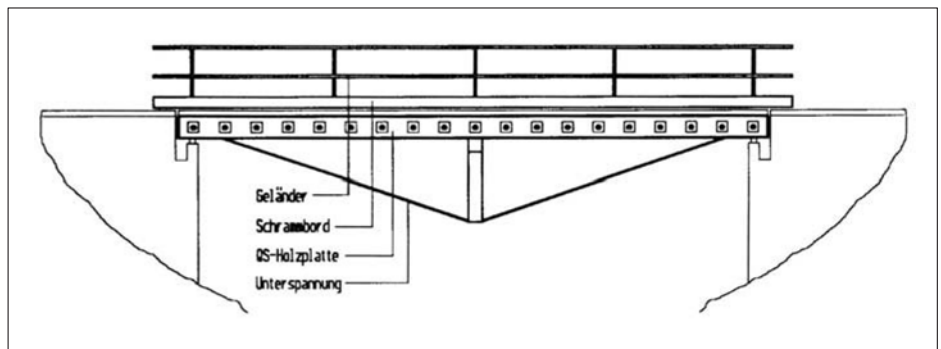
Einfach unterspannte Brücke mit QS-Holzplatte als Fahrbahn
